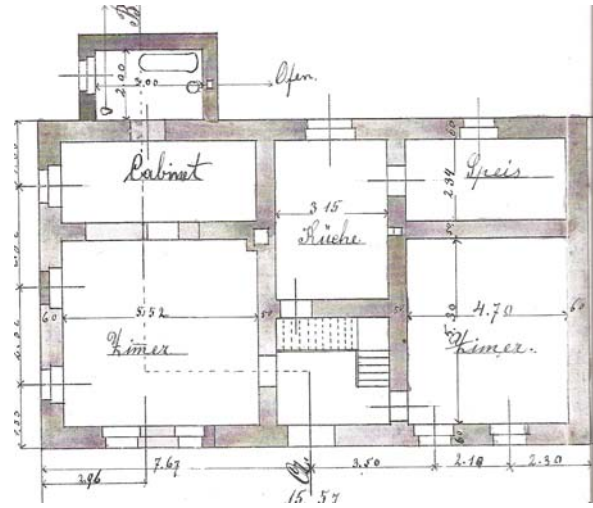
Hoffmann: Bergerhöhe, Grundriss, Einreichplan, 1899
